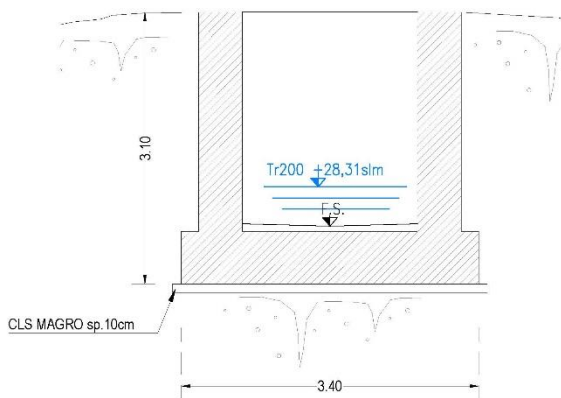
Sezione tipo del manufatto a “u” di imbocco
